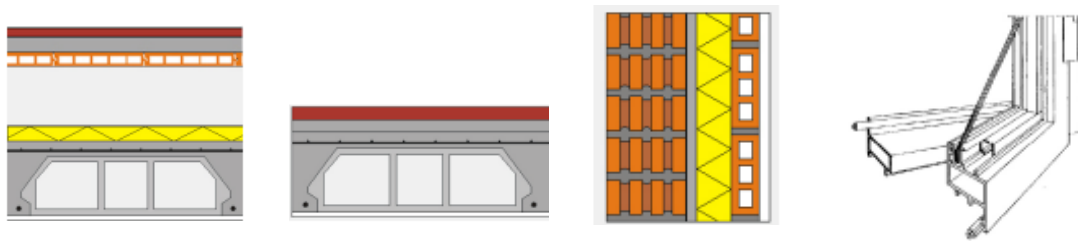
Detalles constructivos Cubierta, Fachada, Carpintería, Forjado. Fuente TABULA [108].
